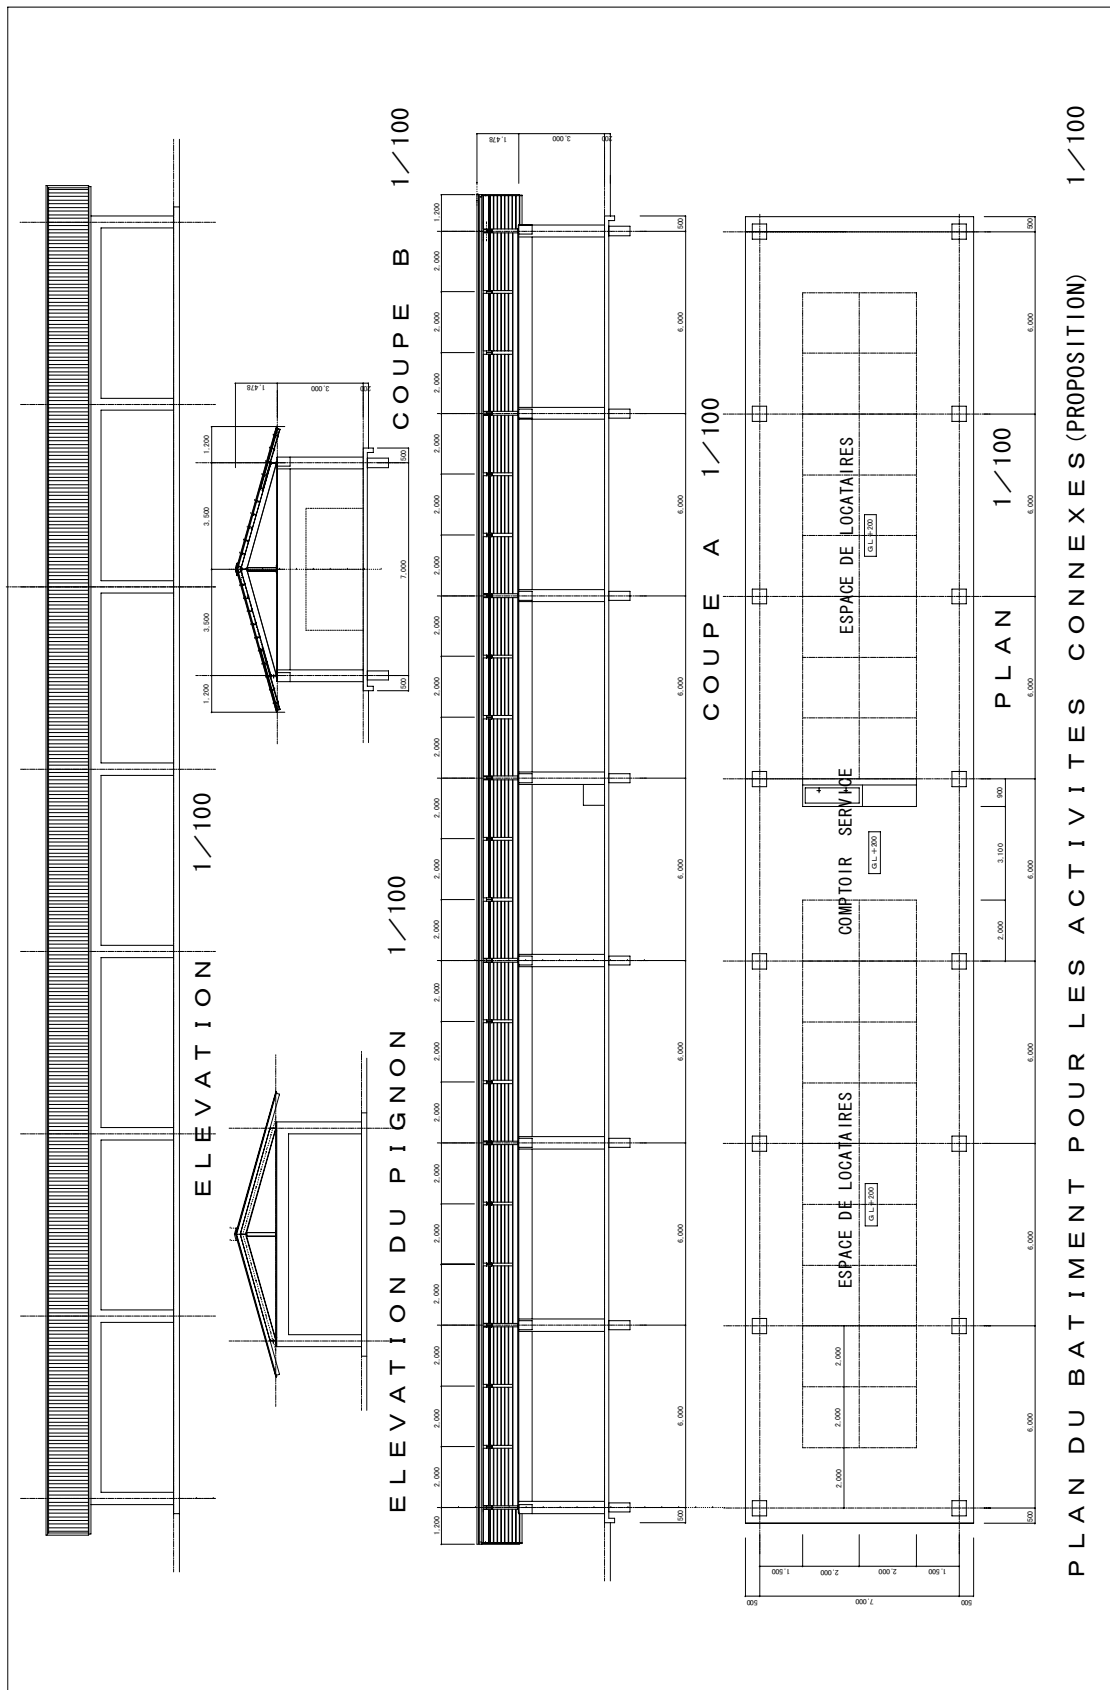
Plan du bâtiment pour les activités connexes (proposition)
